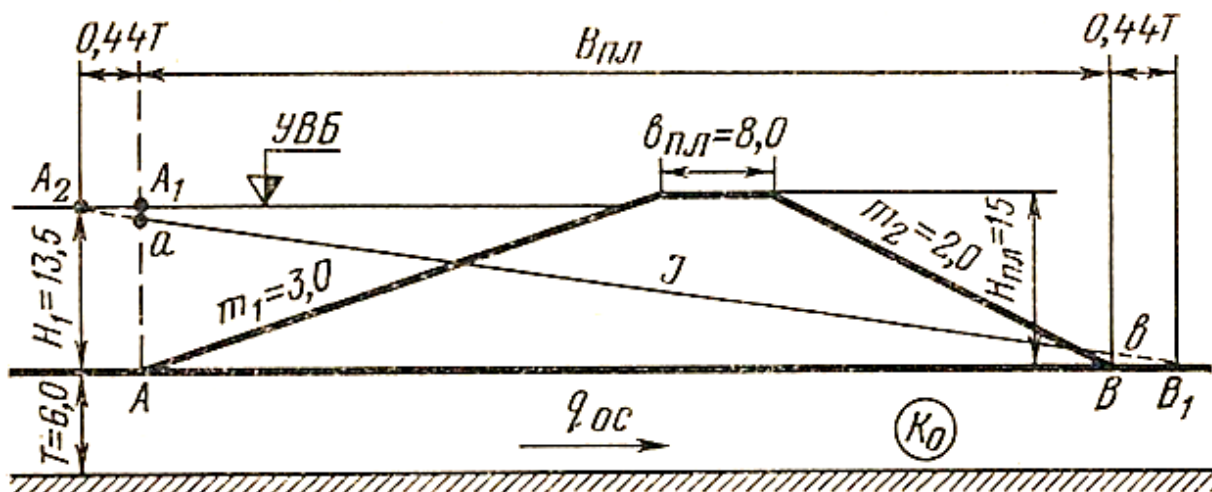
Расчетная схема фильтрации через однородную земляную плотину на водопроницаемом основании конечной глубины без дренажа при отсутствии воды в нижнем бьефе по способу проф. Р.Р. Чугаева
